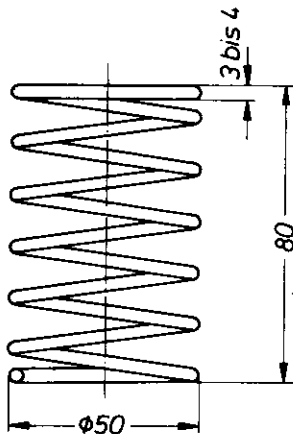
Wendel (Die angegebenen Abmessungen gelten für Bolzendübel $d_1 \geq 12$ mm)
